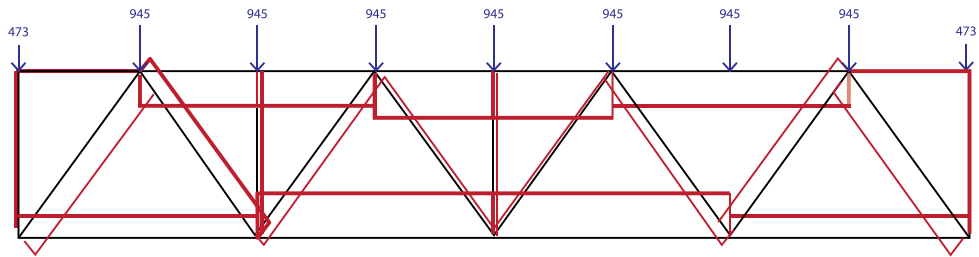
Расчетная схема и эпюры продольных усилий N в ферме
